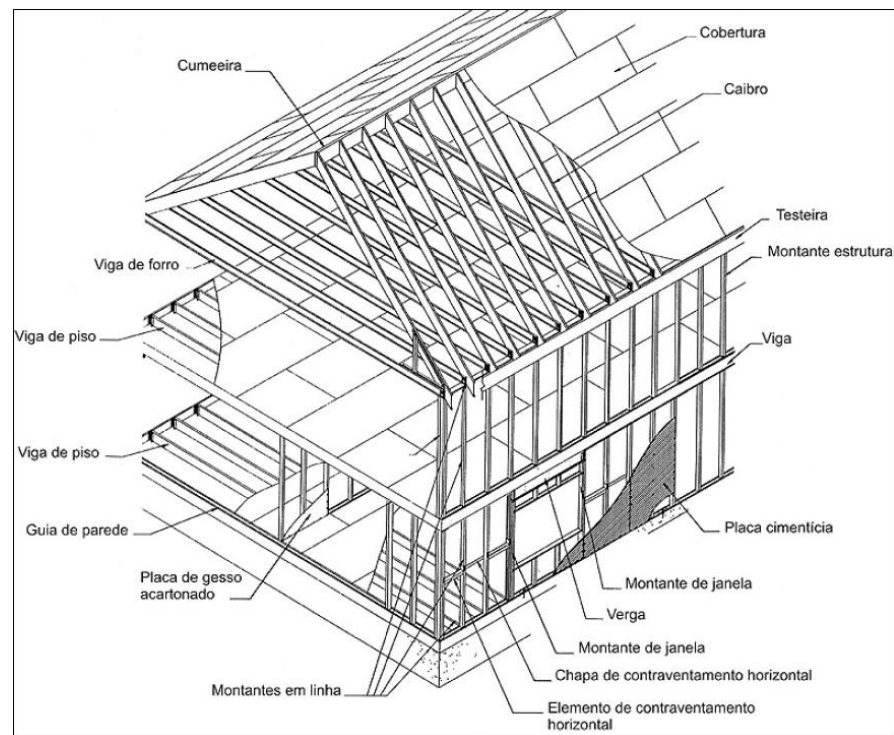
Subestruturas do LSF. Fonte: CBCA - Centro Brasileiro em Construção em Aço.
